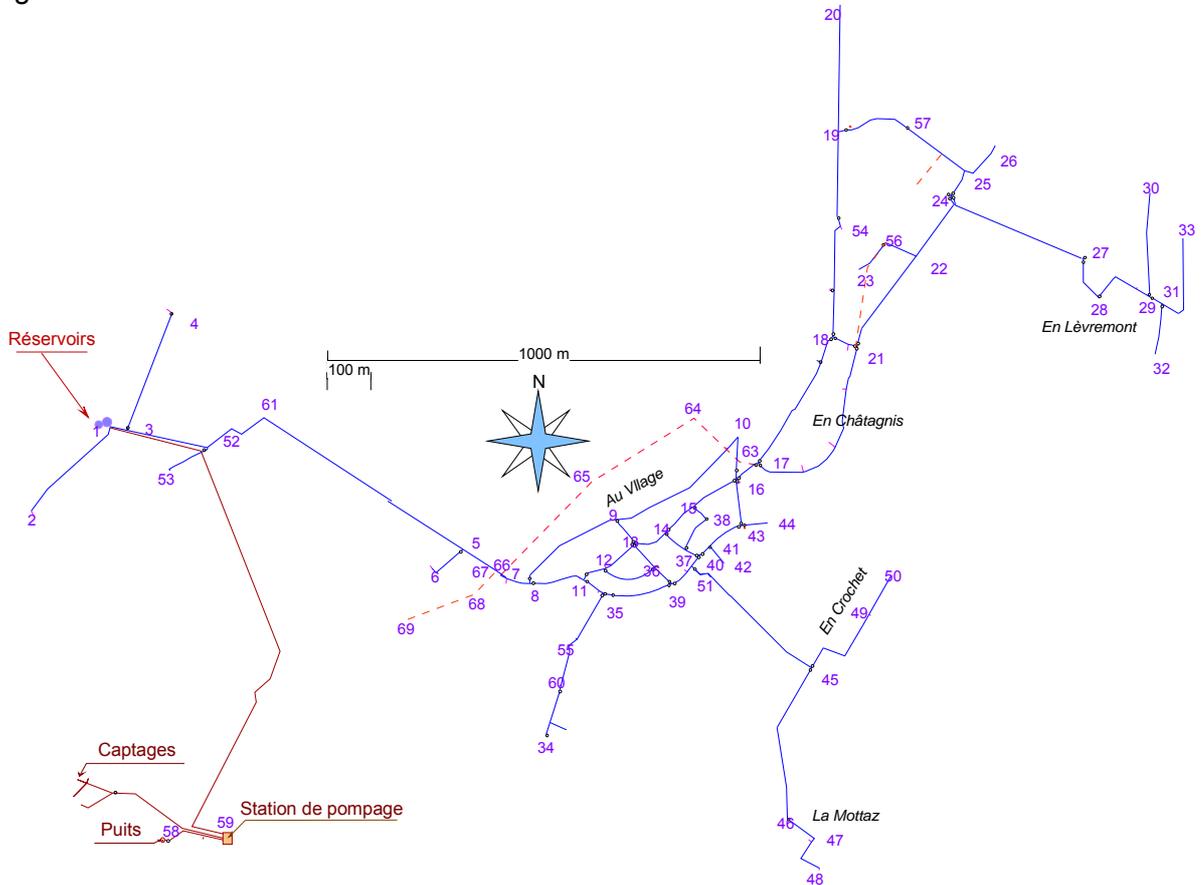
Réseau d'eau d'Apples en plan. En pointillé, conduites en projet.
